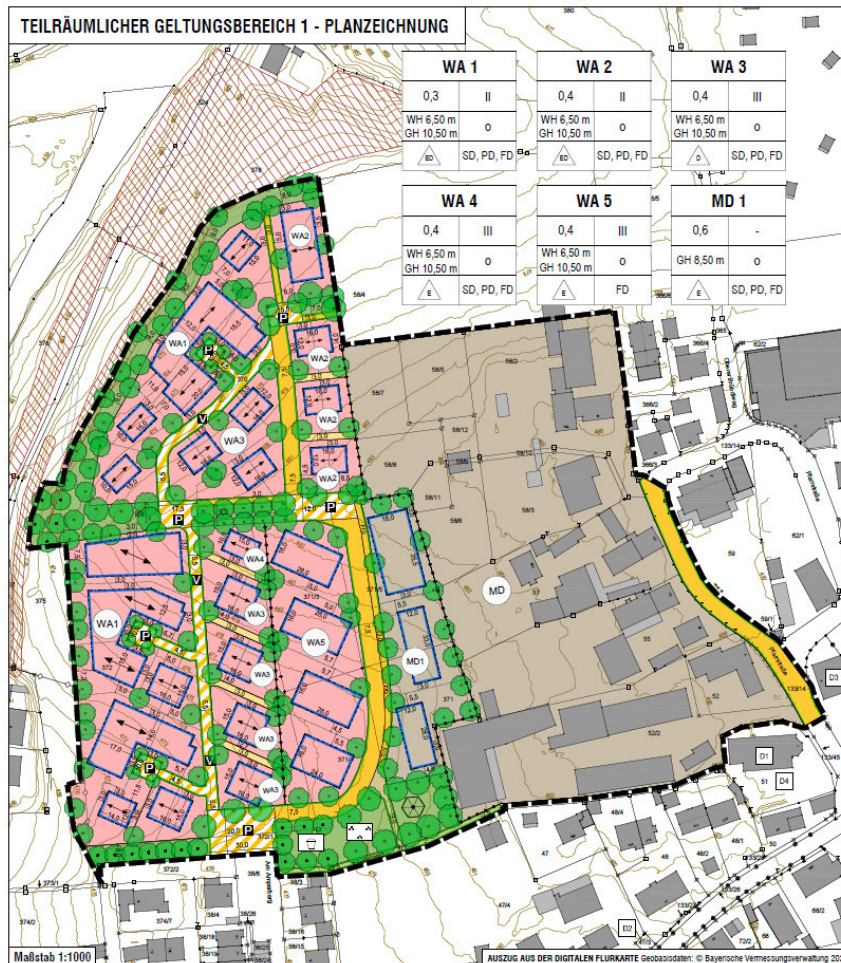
Ausschnitt Geltungsbereich Bebauungsplan „Nördlich des Amperbergs“, Quelle Karte: OPLA Architekten & Stadtplaner Augsburg
